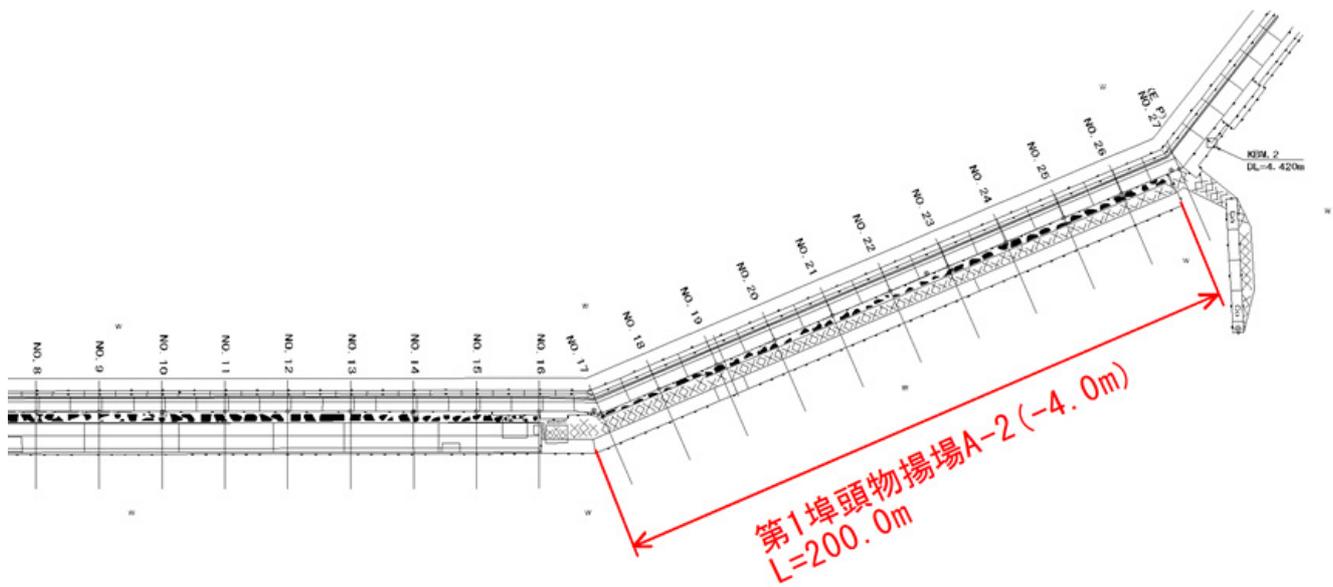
280 No.31 大洗港区_第1埠頭 A-2 物揚場 (-4.0m) の平面図 (被災前)
